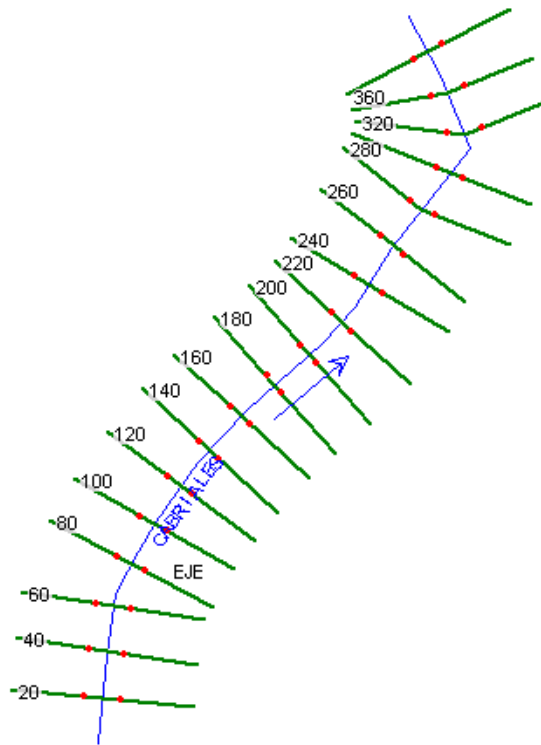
Vista de planta de la sección exportada del AutoCAD Civil 3D.
